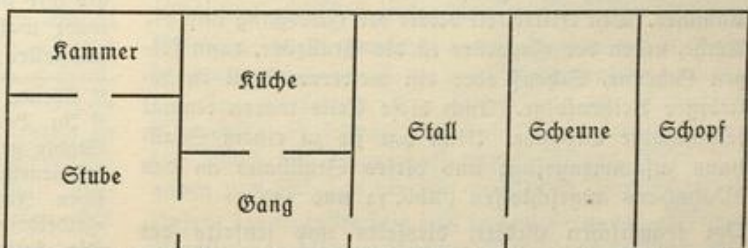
Grundriß eines nach dem Dreißigjährigen Kriege üblichen Hauses in Oberdeutschland. Zeichnung von Hans Fehrlé.
